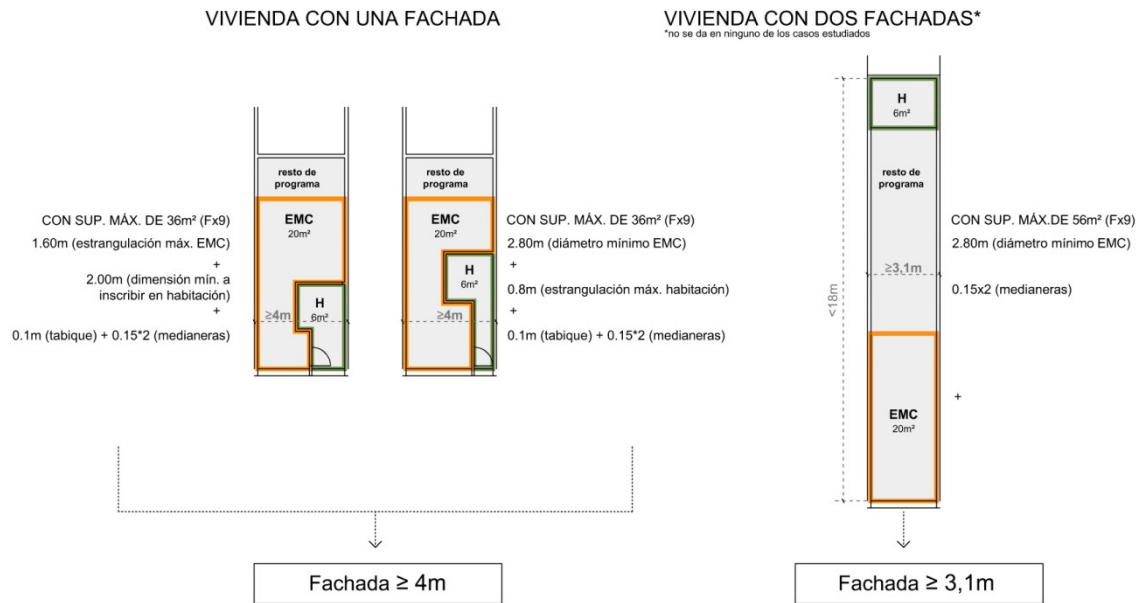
Posibilidades de agregación de EMC + H, utilizando el mínimo de fachada necesaria. Elaboración propia
